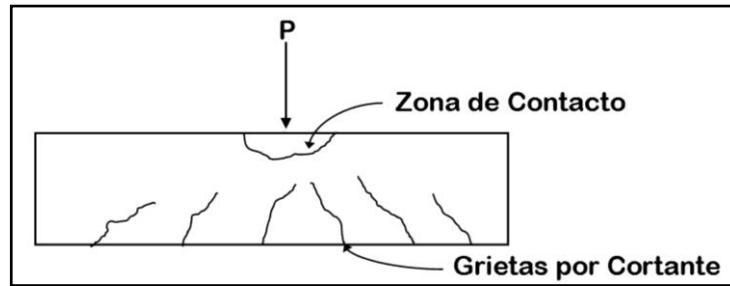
Fallas por Cortante en Vigas de Concreto Armado por colocación de elementos no contemplados en el diseño estructural.
